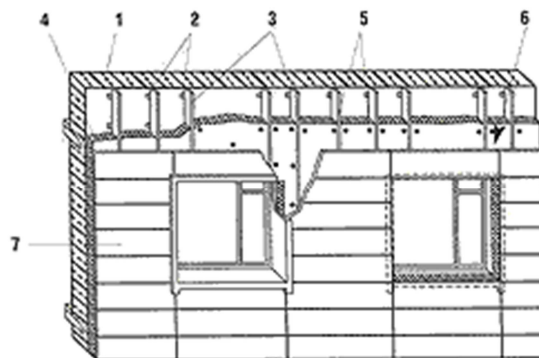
Схема устройства «вентилируемого» фасада с защитно-декоративными экранами: 1 – утепляемая стена; 2 – узлы крепления направляющих; 3 – металлические направляющие; 4 – утеплитель, покрытый ветрозащитным материалом; 5 – дюбели; 6 – воздушная прослойка; 7 – наружная облицовка
